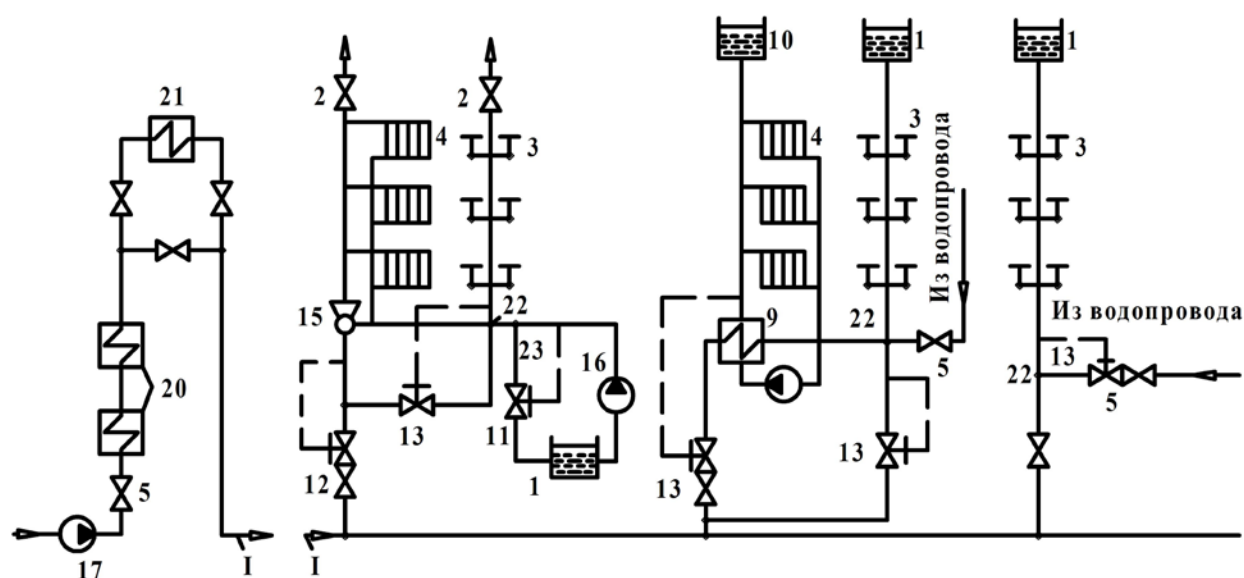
Тепловая схема однотрубной водяной системы теплоснабжения
